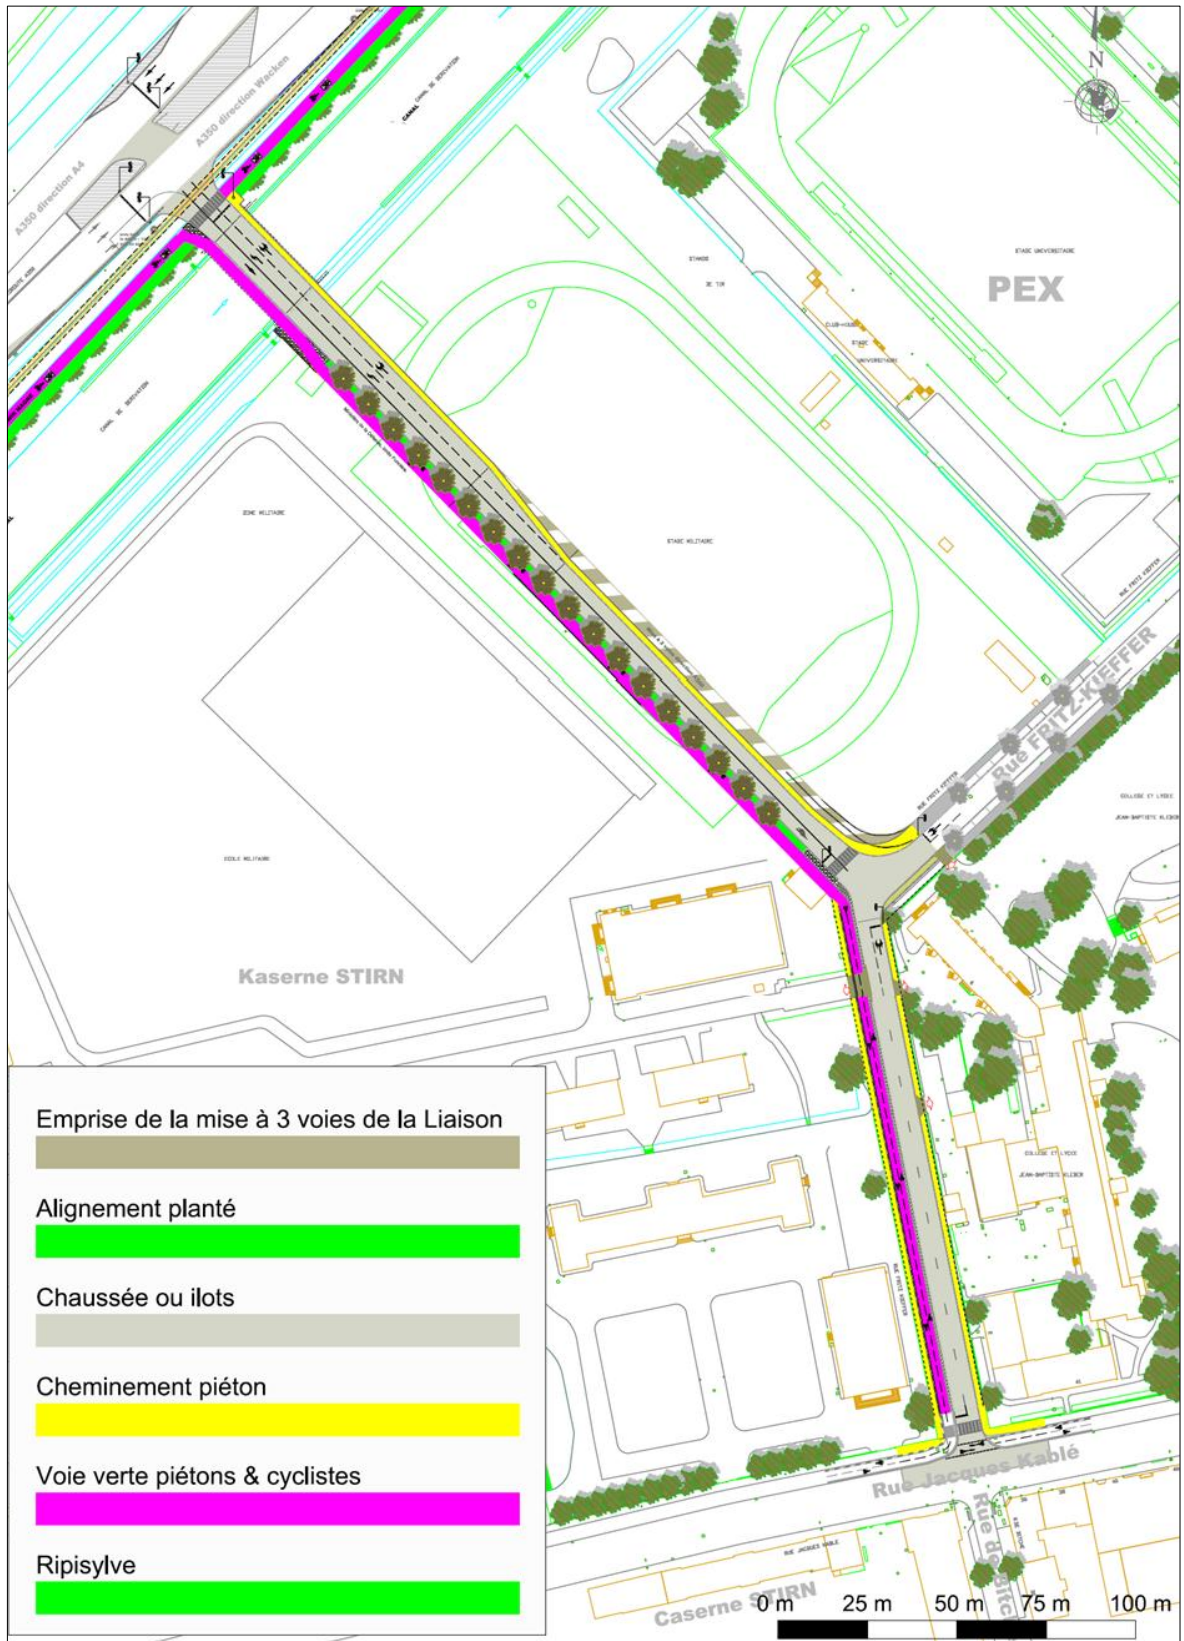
Plan AVP du projet de liaison routière (février 2014)
